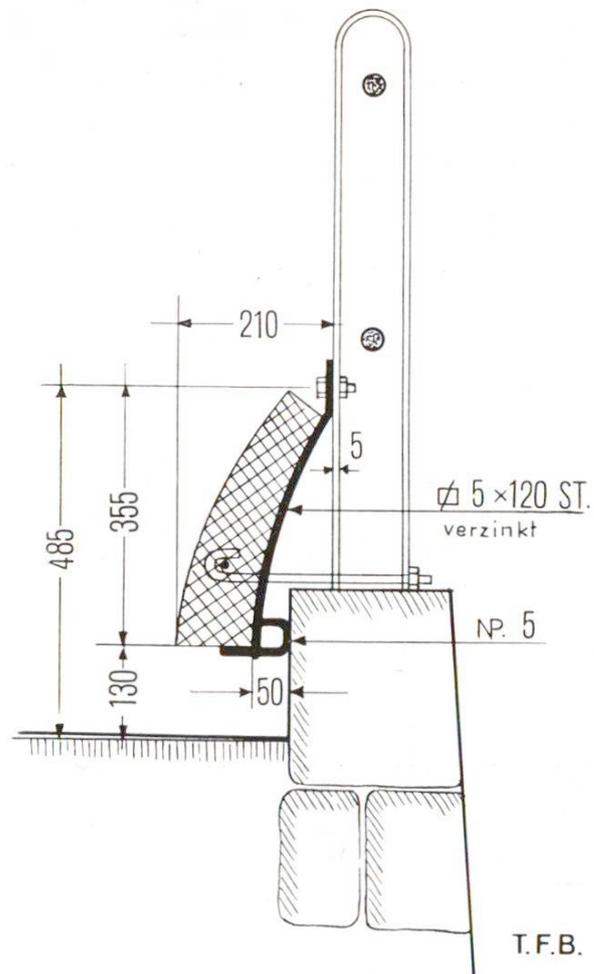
Schema für Befestigung der Leitschranke an Sockel mit Geländer
